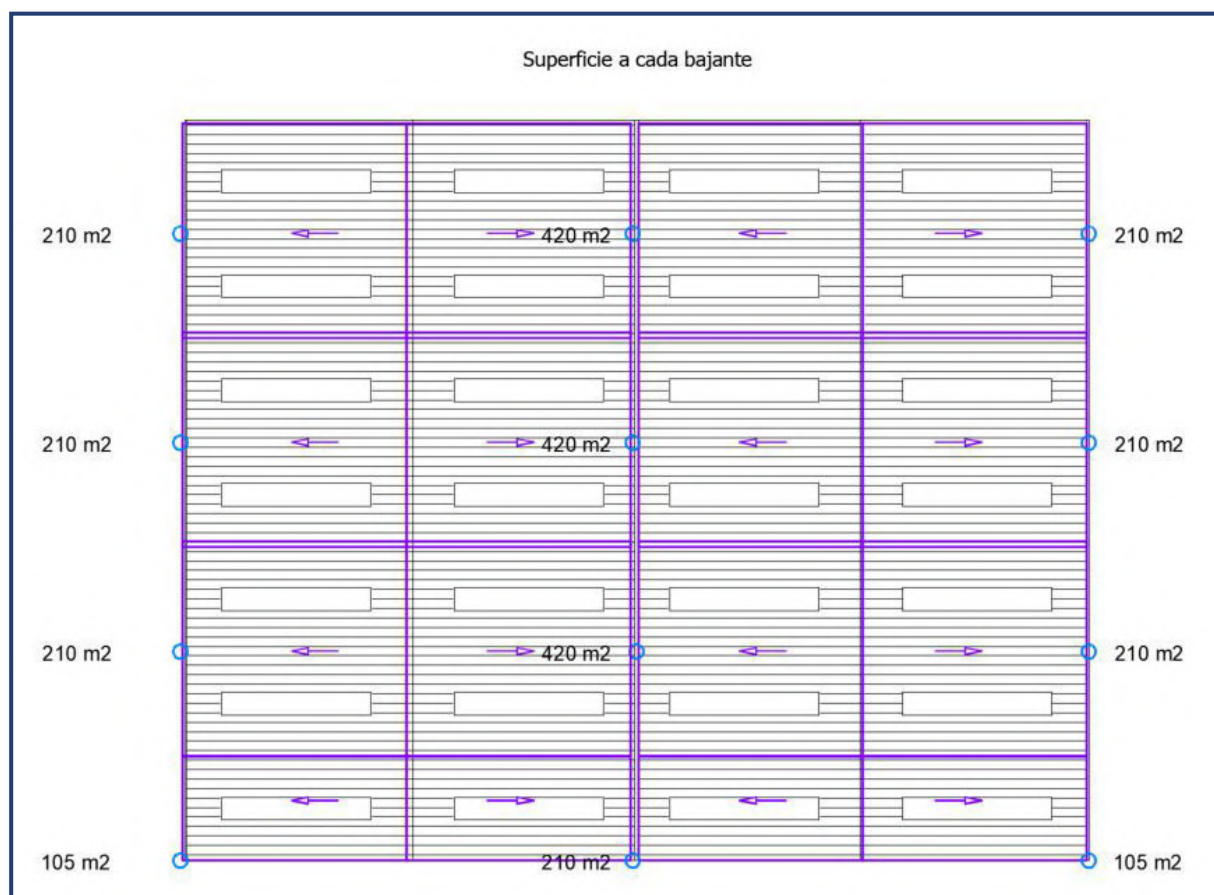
Superficie real cubierta por cada bajante y canalón.
